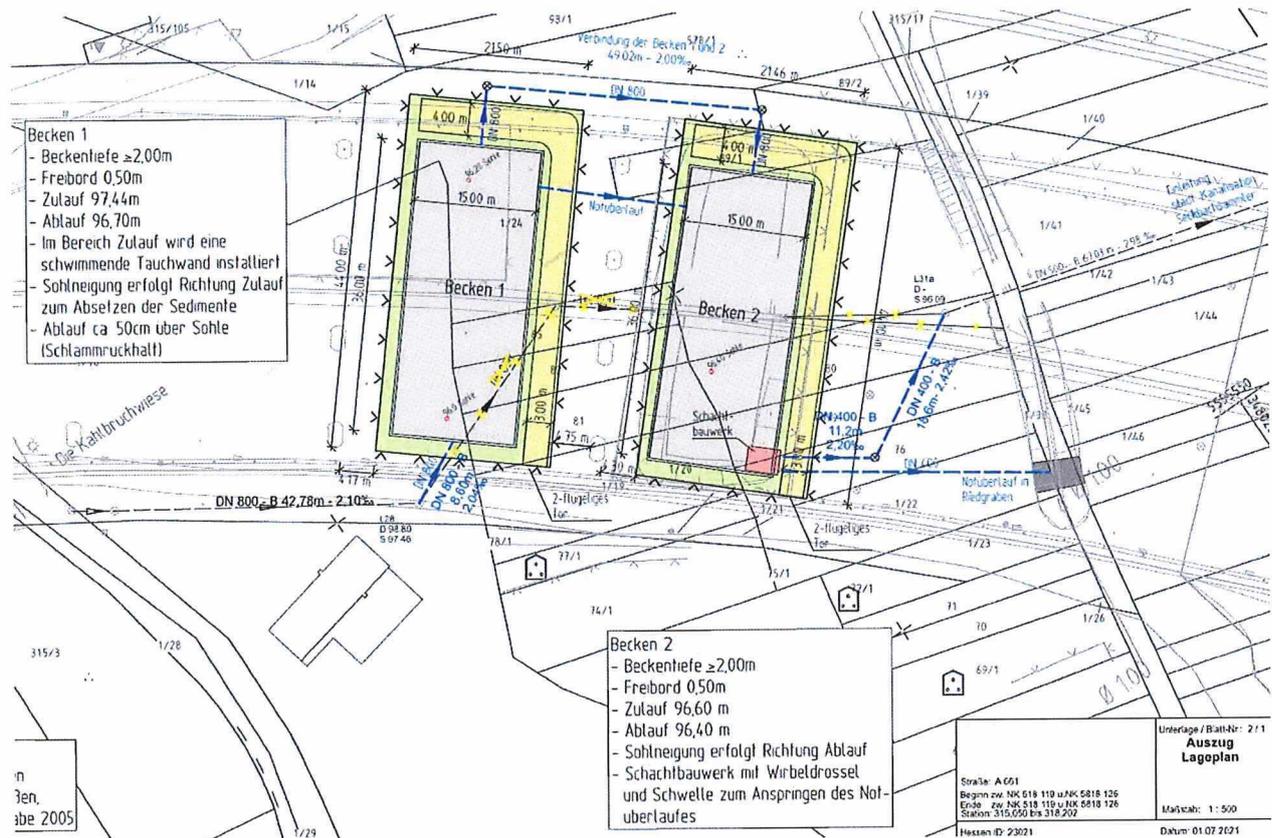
Lageplan RRB 3, Planung mit 2 Becken
